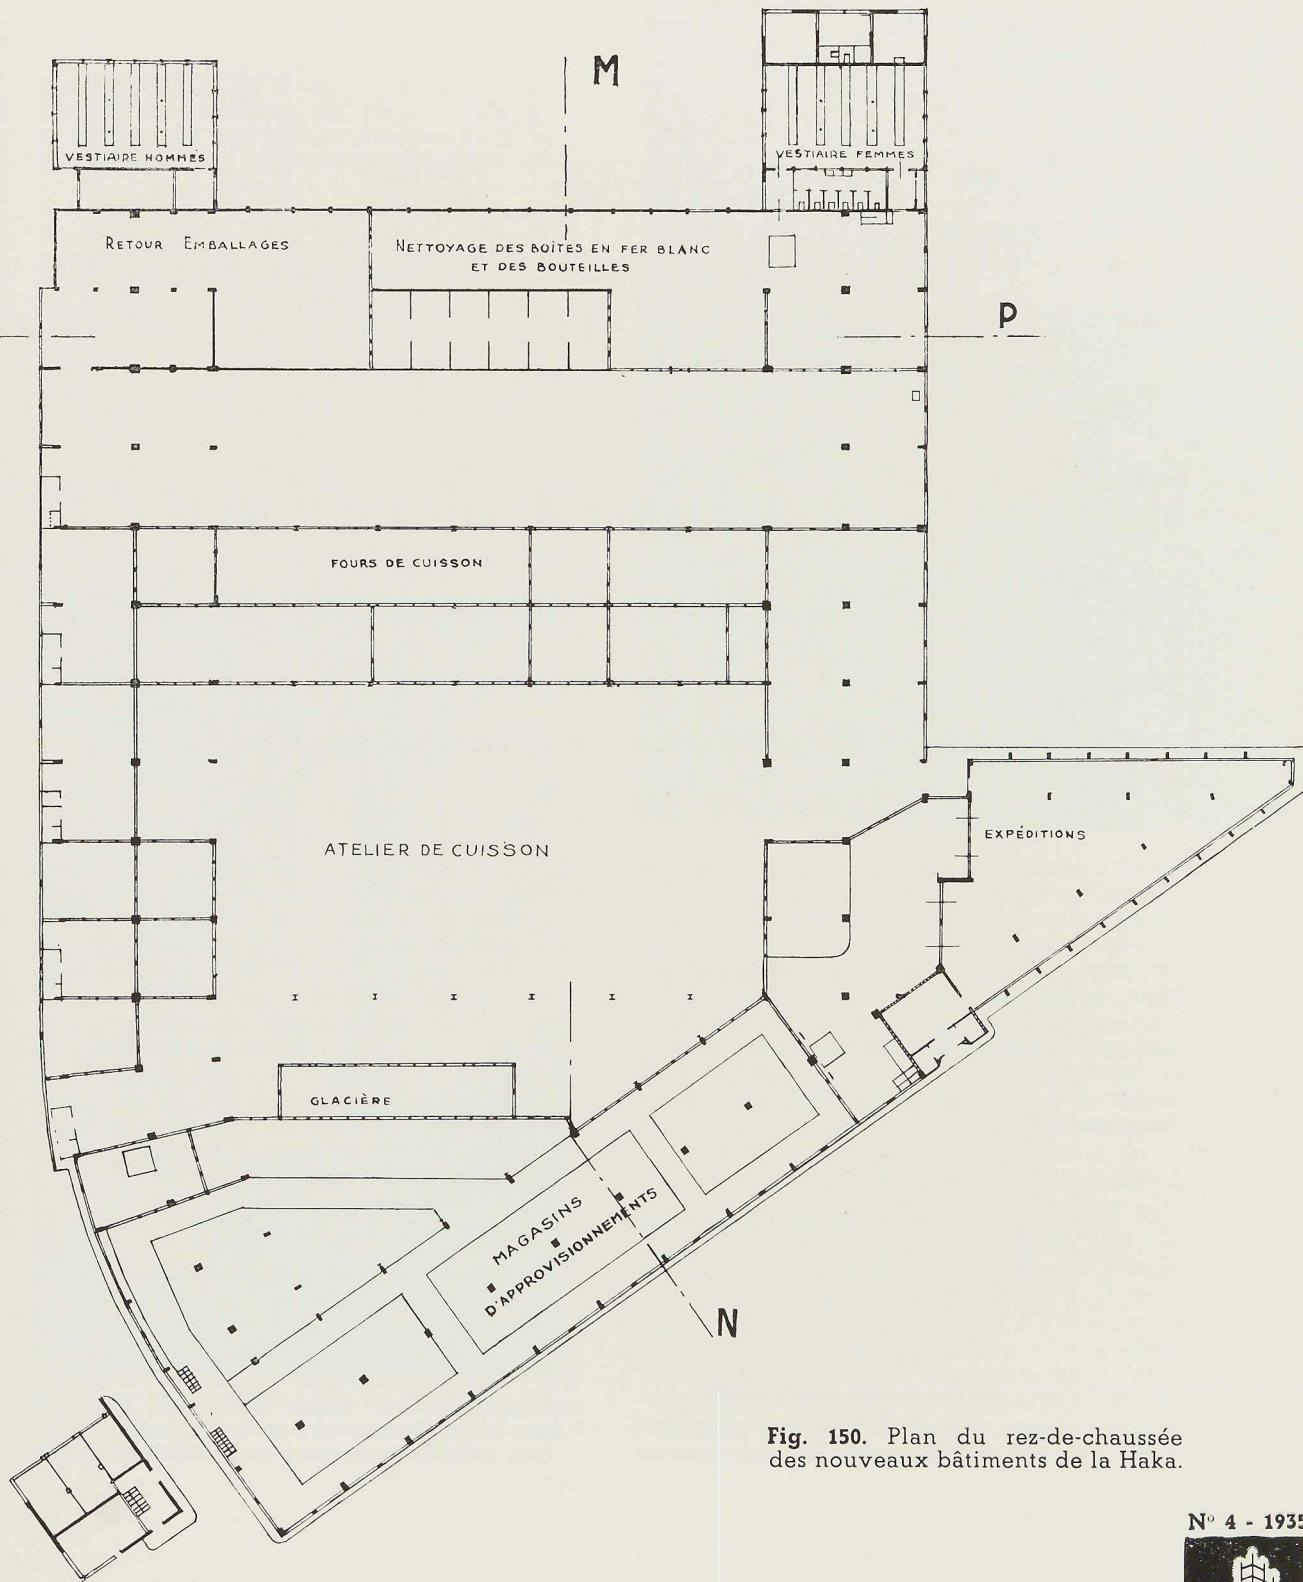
Plan du rez-de-chaussée des nouveaux bâtiments de la Haka.
